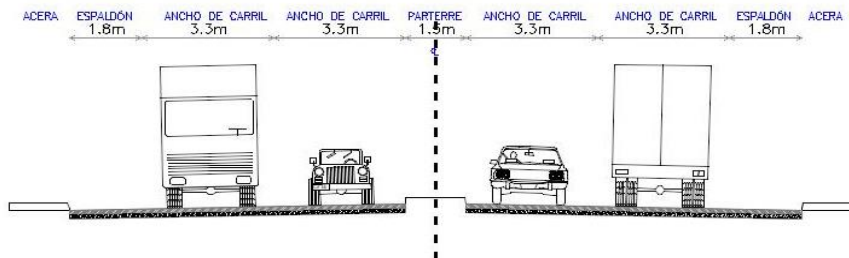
Sección típica Vía Principal 1+291.4 – 2+251.9
